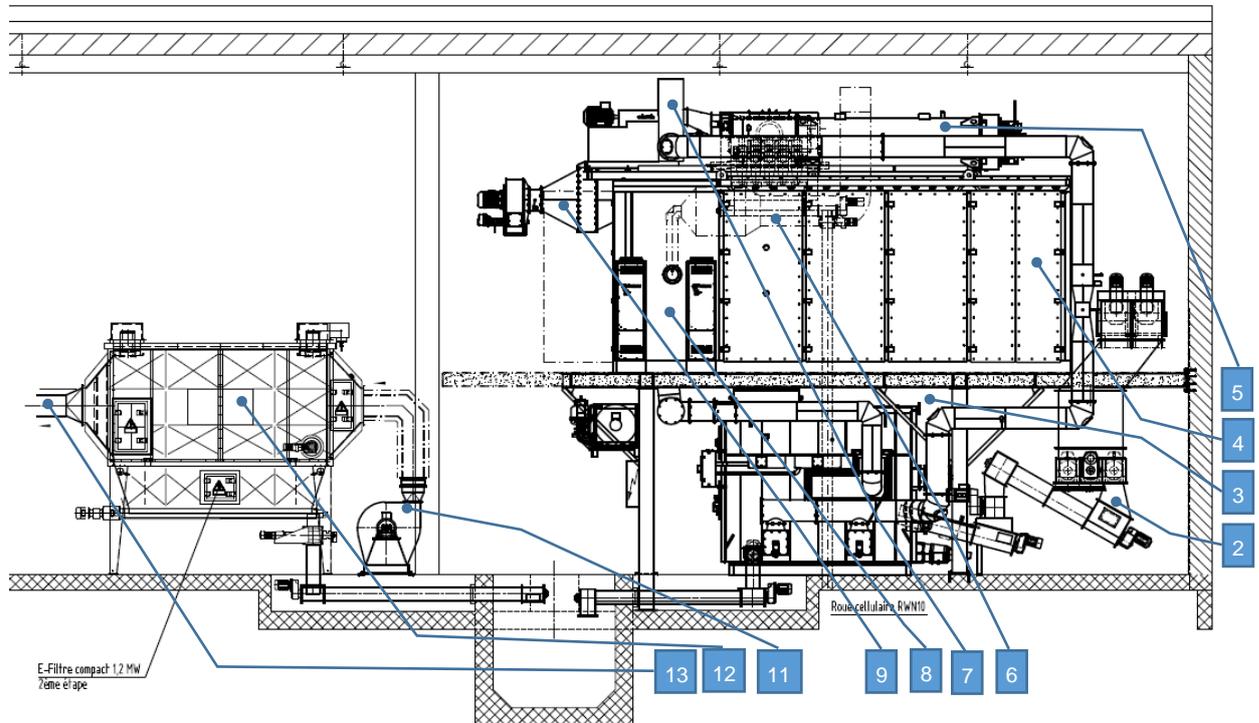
Grundriss des Einbauplanes der Heizzentrale in Düdingen
